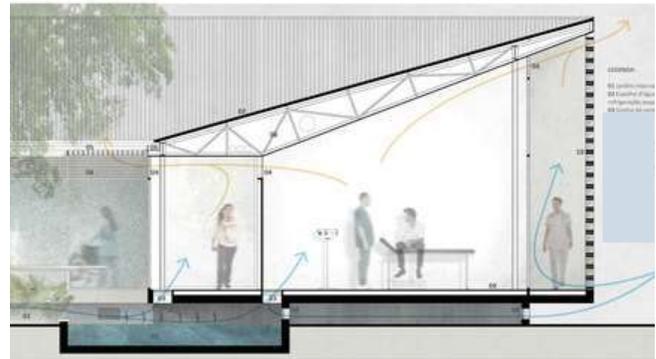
Sistema constructivo. Fuente: Plataforma Arquitectura.
